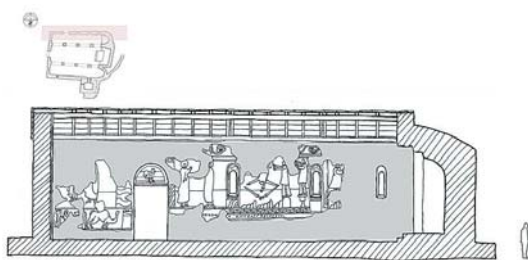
Sant Joan de Boí: croquis del muro norte, nave norte.
